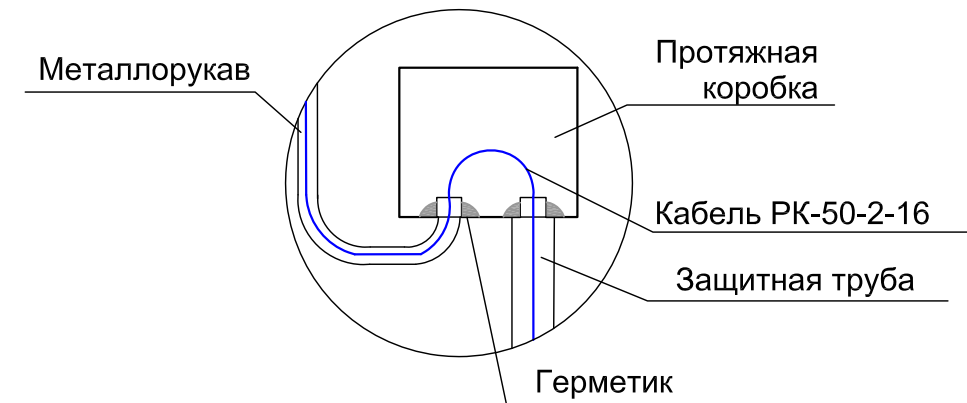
Прокладка соединительного кабеля через протяжную коробку
